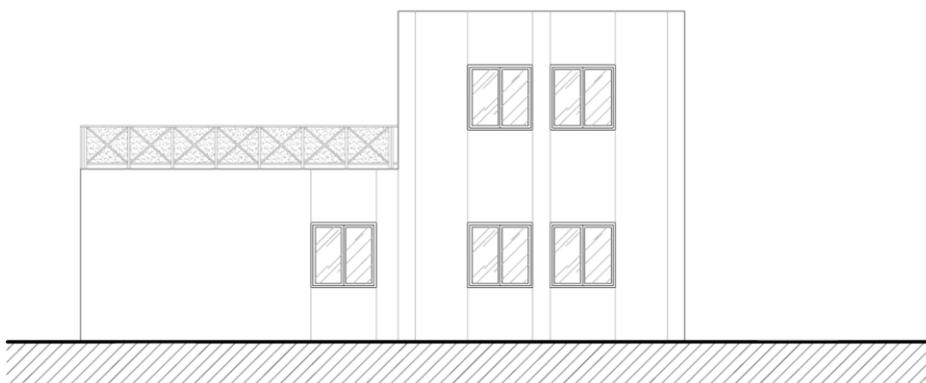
“Piccola palazzina per uffici. Prospetto Est”
